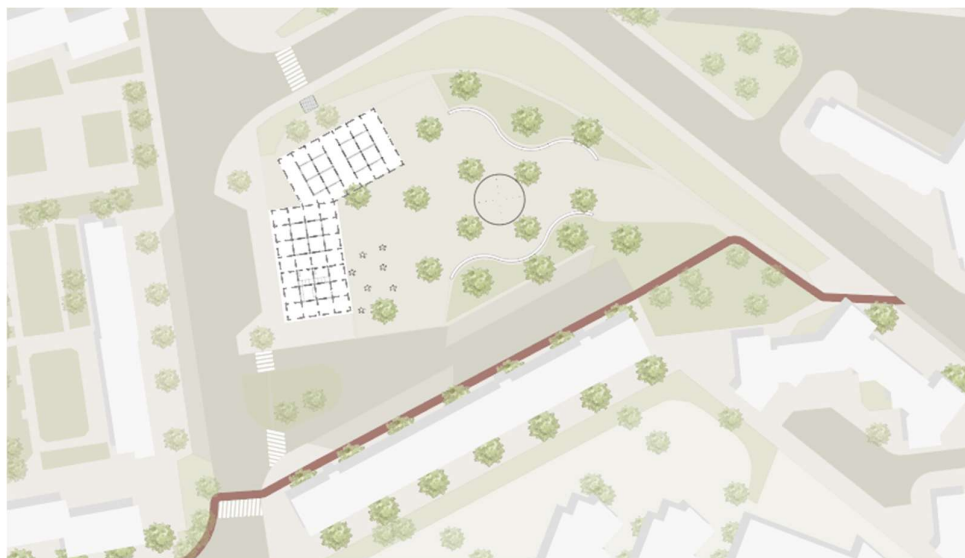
Planta da proposta da nova implantação do Mercado da célula E e da praça realizado pela autora através da ferramenta digital AutoCAD em 1/05/2025
